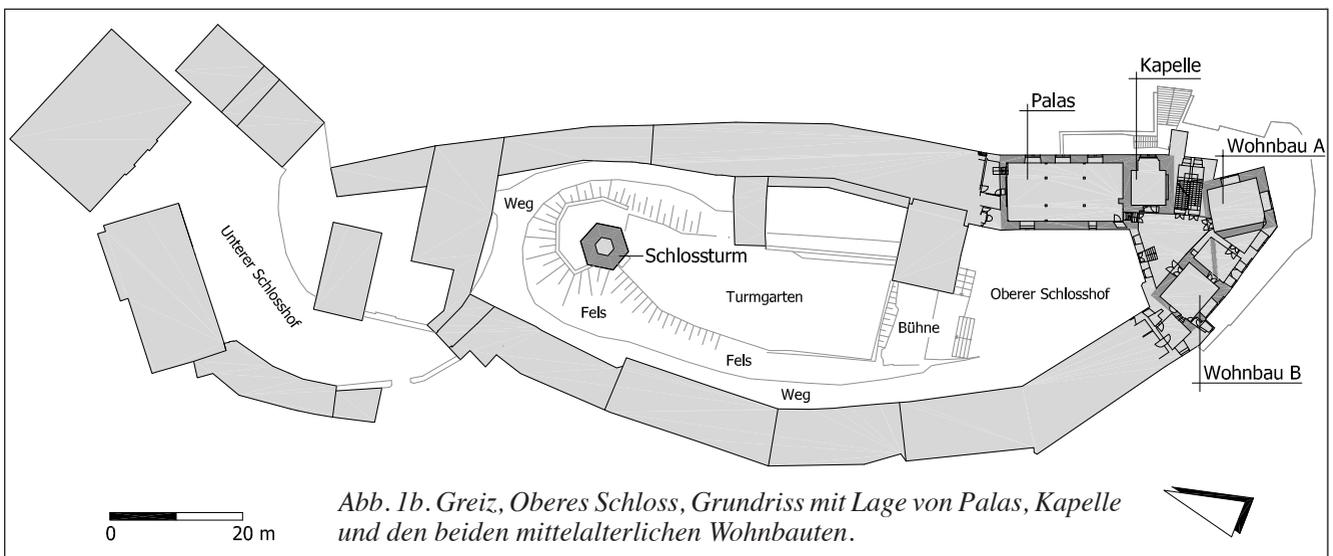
Greiz, Oberes Schloss, Grundriss mit Lage von Palas, Kapelle und den beiden mittelalterlichen Wohnbauten.
